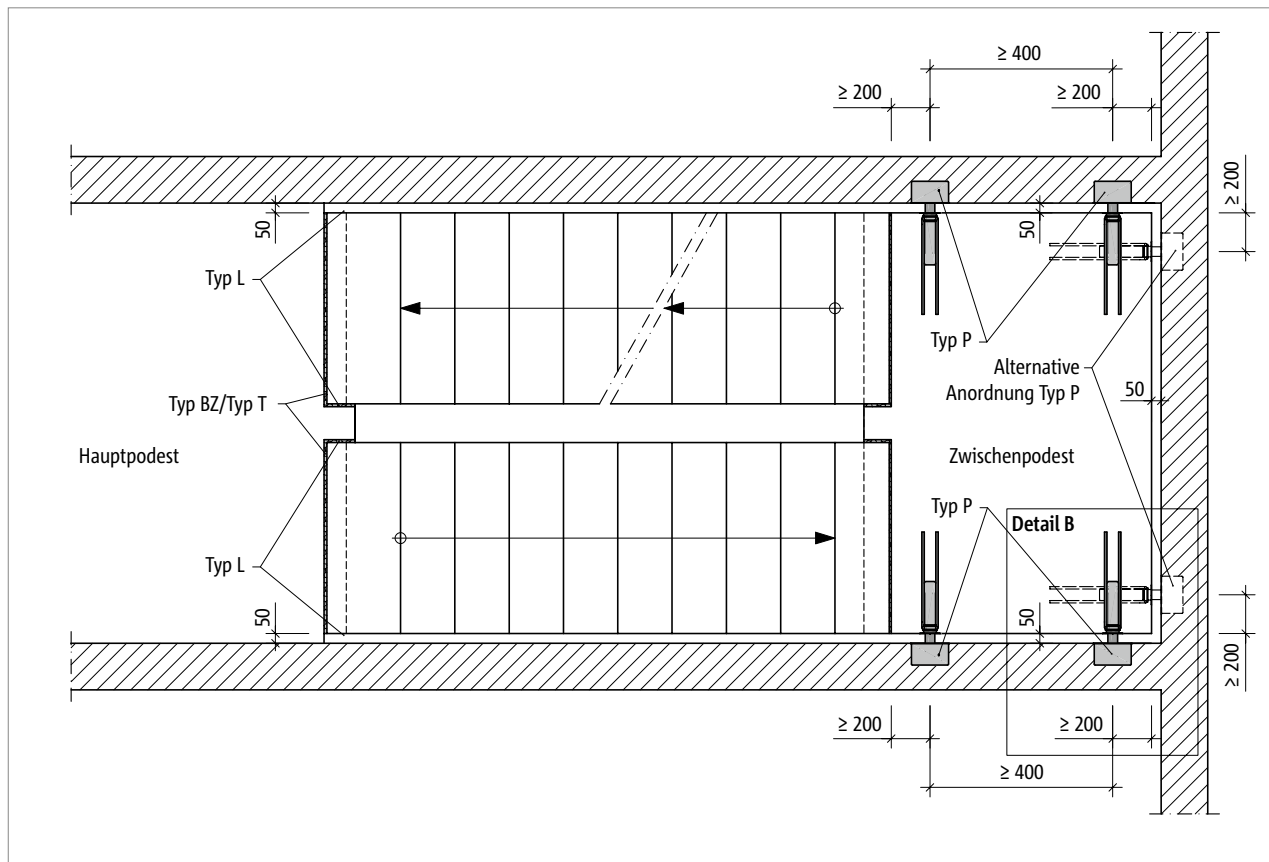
Schöck Tronsole® Typ P: Elementanordnung, Detail B
